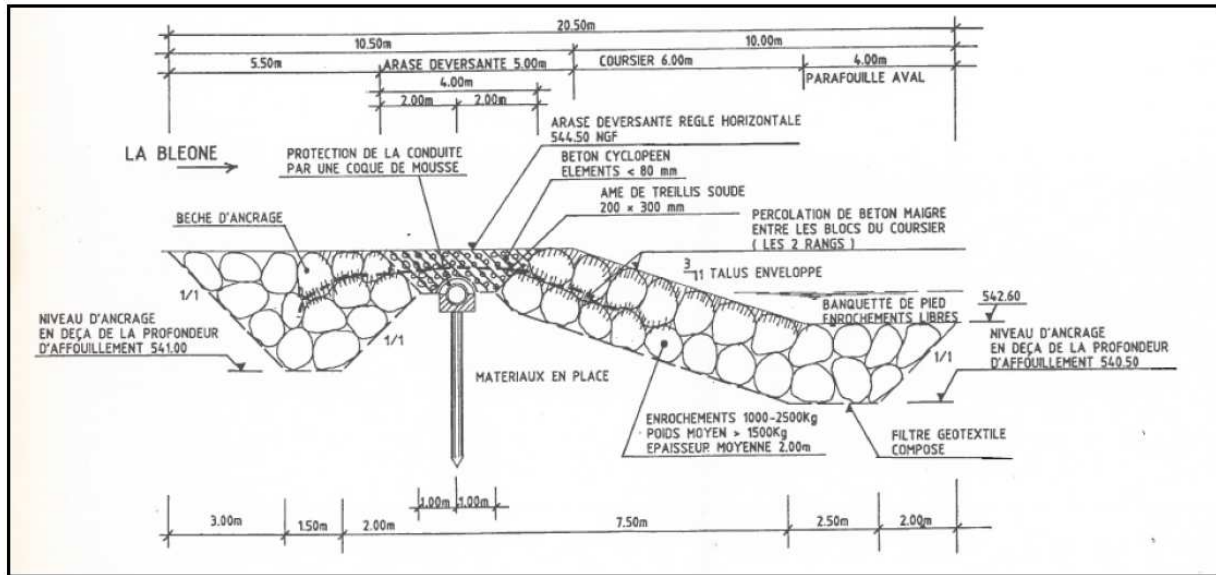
Coupe type du seuil de la canalisation d'eaux usées (plans d'exécution des travaux de construction en 1997)
